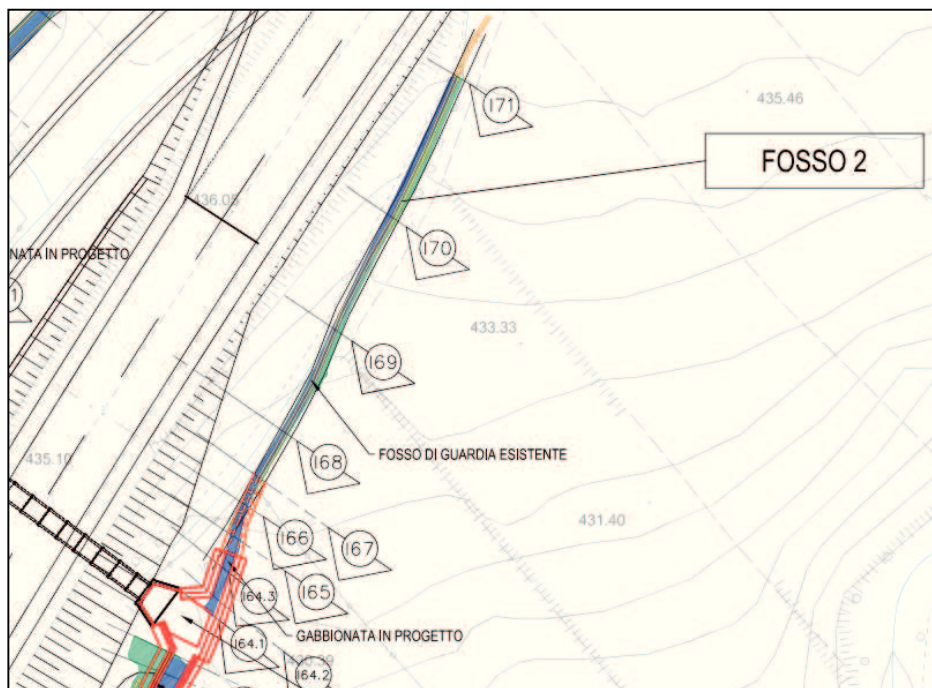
Stralcio planimetria aree esondabili in condizioni di stato di fatto e di progetto TR 100 anni – fosso 2
